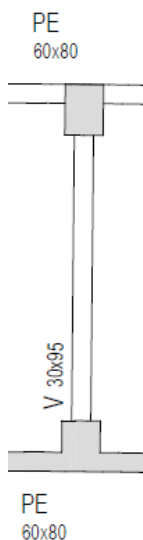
DETALHE TÍPICO DOS PILARES - EIXOS E2, E3, E5, E7, E13, E15, E17 E E18
